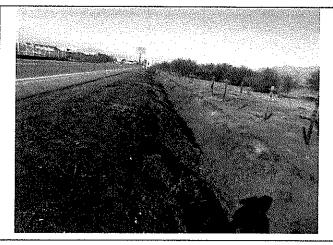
Alcantarilla sin su sección libre en un 90%, cercano a kilómetro 13,5, camino rol G-18. (20-08-2013)
